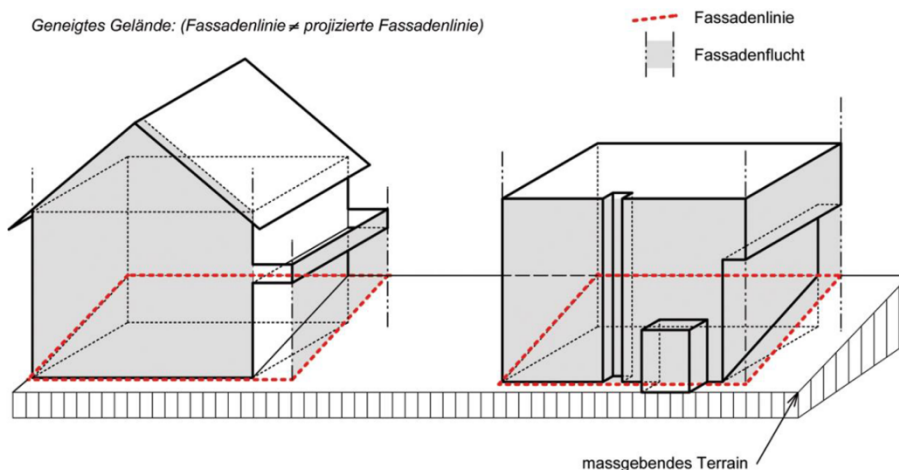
Darstellungen gemäss Leitfaden "Harmonisierung der Baubegriffe", Baudirektion, 1. März 2017
